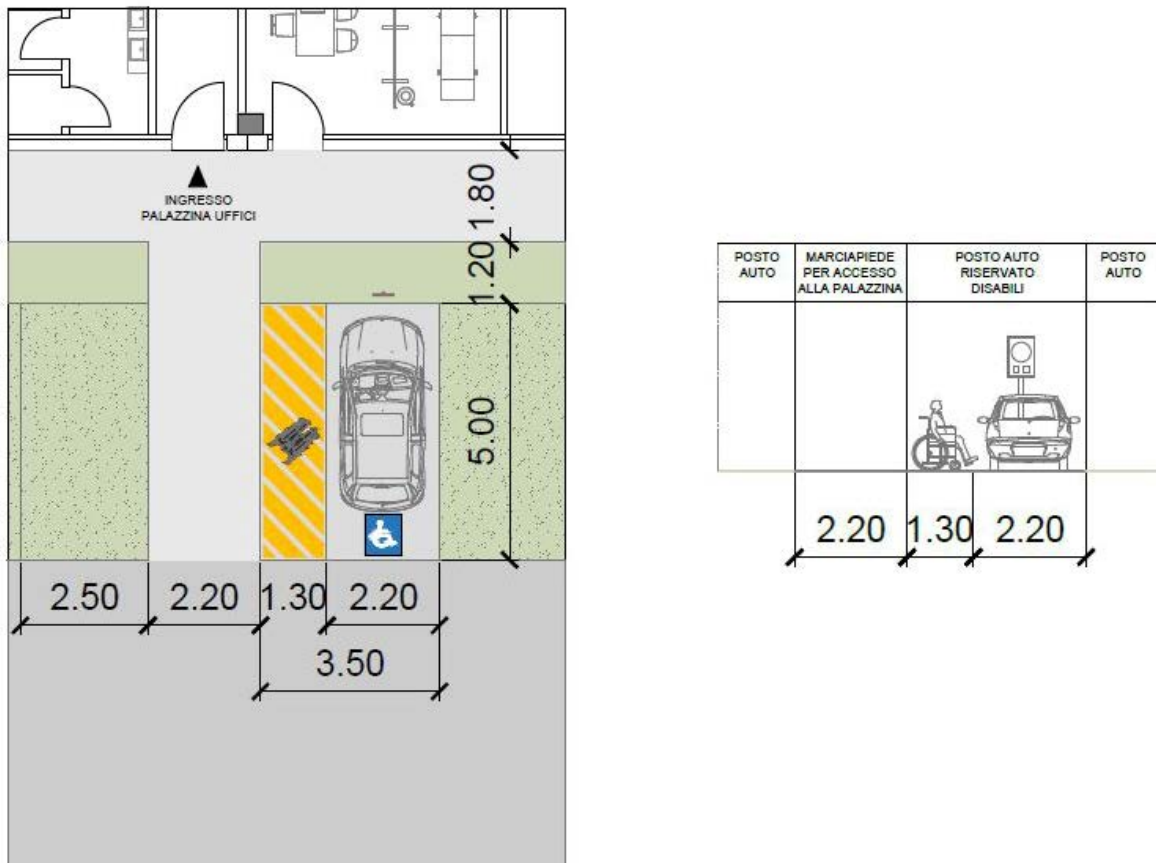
Planimetria e prospetto posto auto riservato a persone disabili
